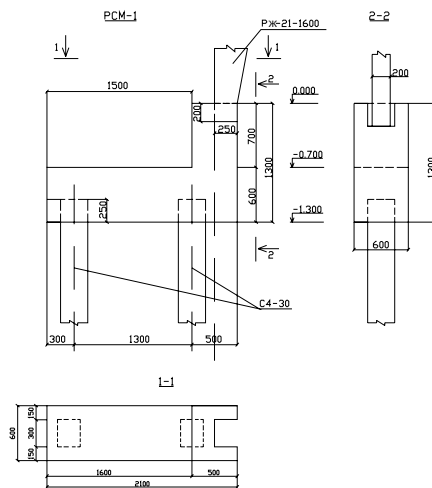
Конструкція палевого фундаменту із монолітним ростверком з консоллю в будинку плавального басейну
